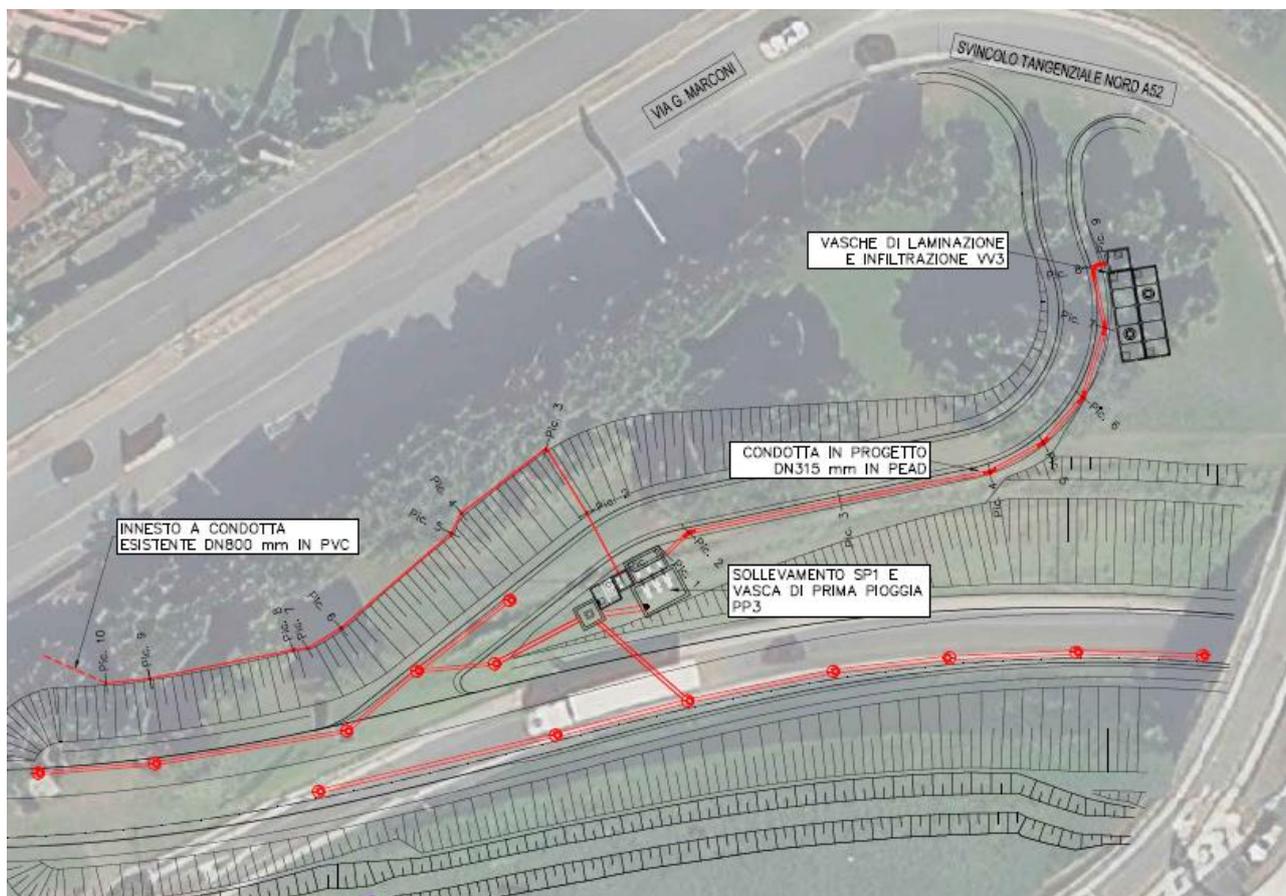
Stralcio planimetrico del sistema di drenaggio del Ramo 1 e delle Gallerie (GA01 + GA02 + TR02)
